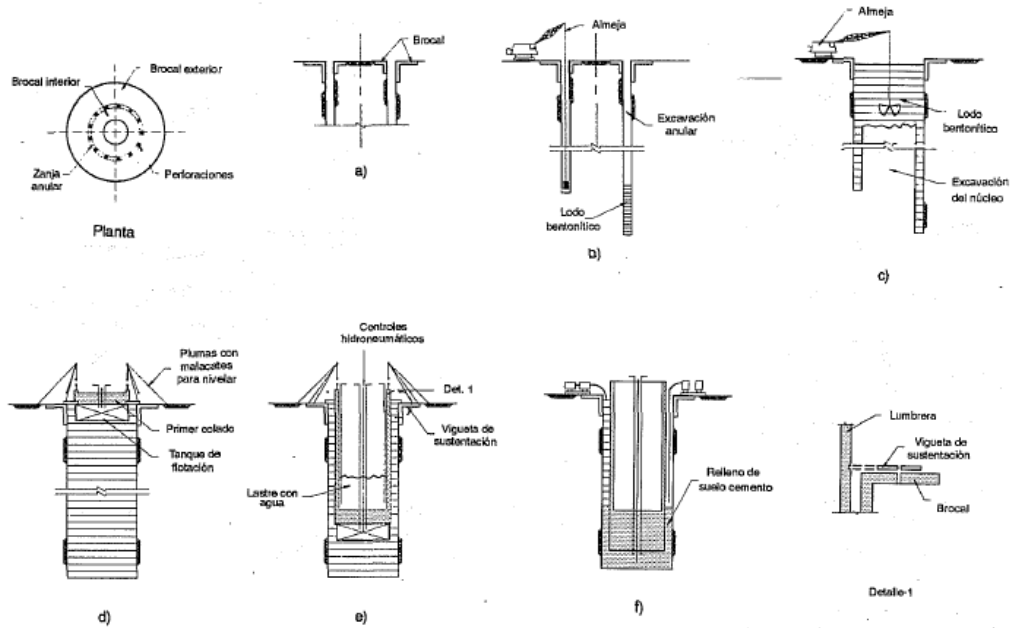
Construcción de Lumbrera por flotación.*²⁹
